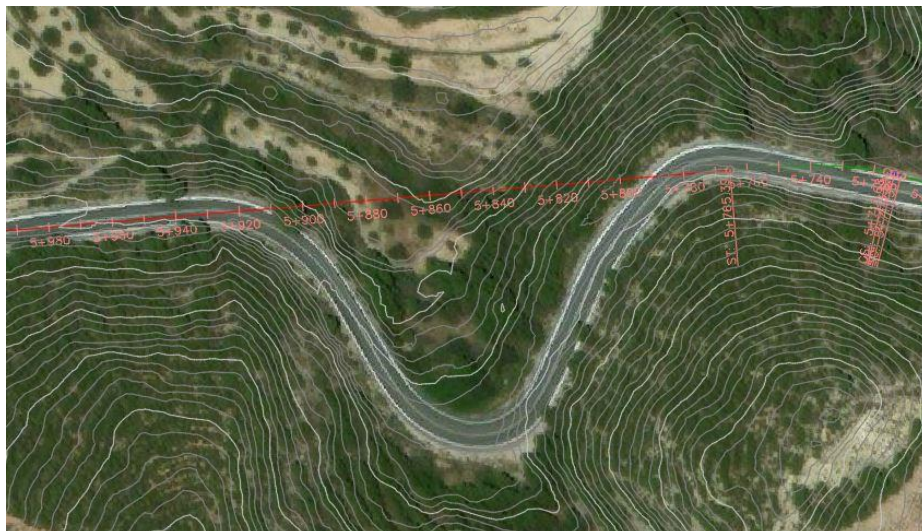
Localización de obra de drenaje transversal en vaguada (P.K 5+840). Fuente, Civil 3D
